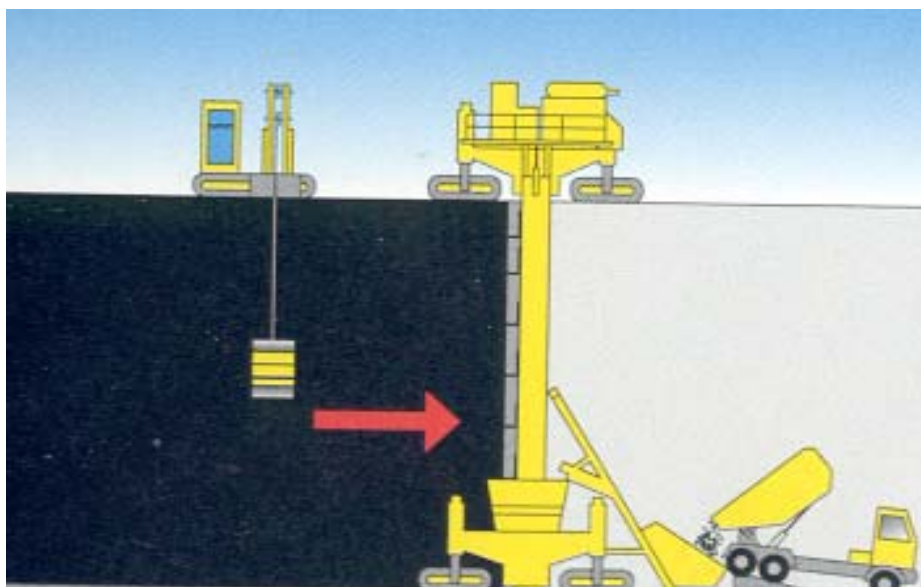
Esquema construtivo da face de concreto asfáltico utilizando pavimentadora horizontal (Walo, 1997a).
